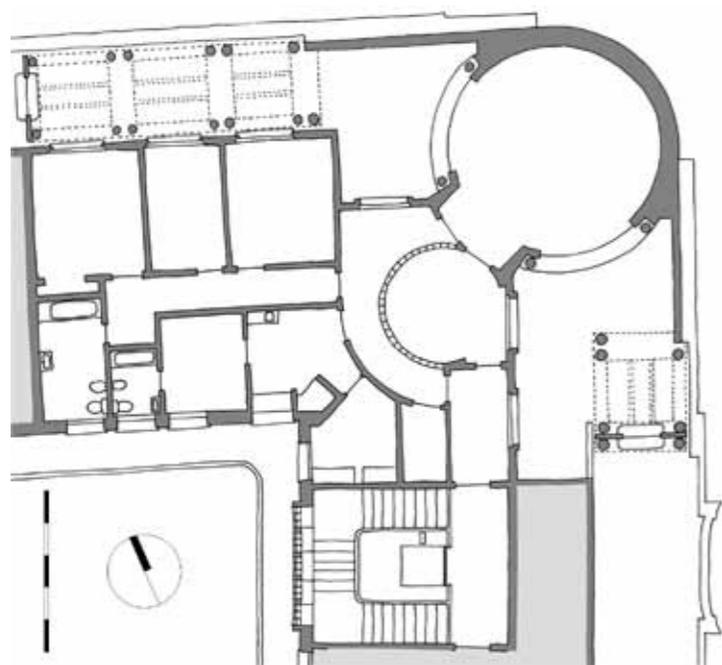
Esboço da organização em planta de um apartamento de cobertura
